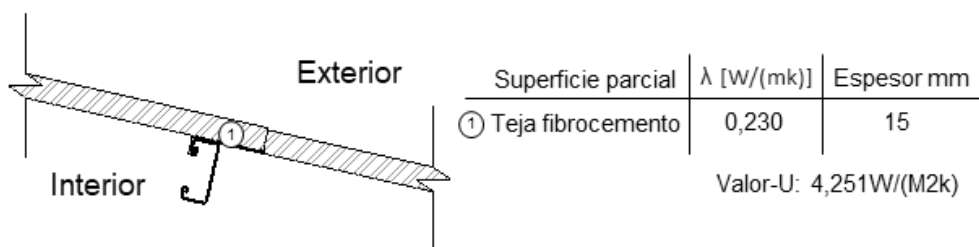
Detalle de elemento constructivo de cubierta. Fuente: elaboración propia
